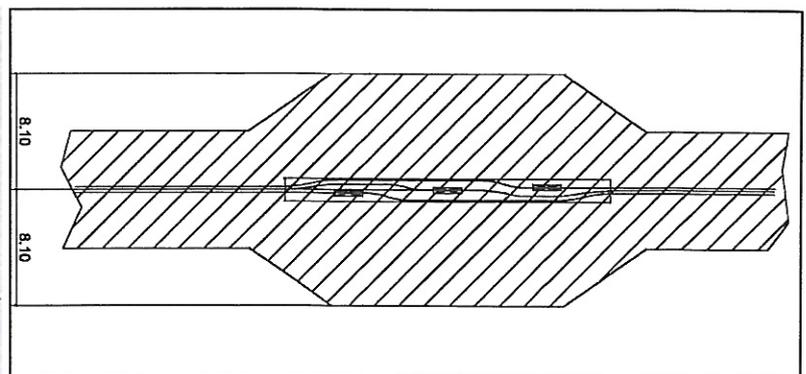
Rappresentazione planimetrica della fascia di rispetto (DpA)
